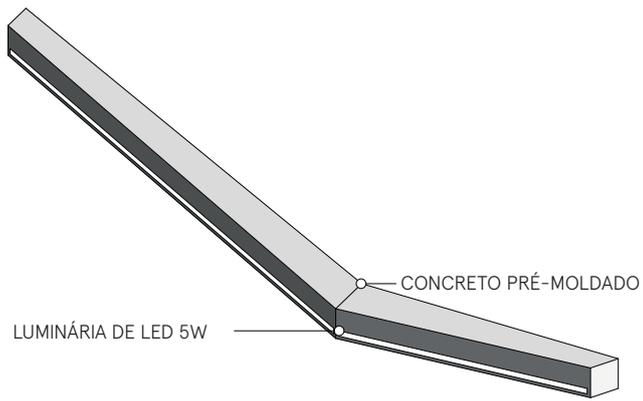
Bancos em concreto pré-moldado para a Praça da Sé |
